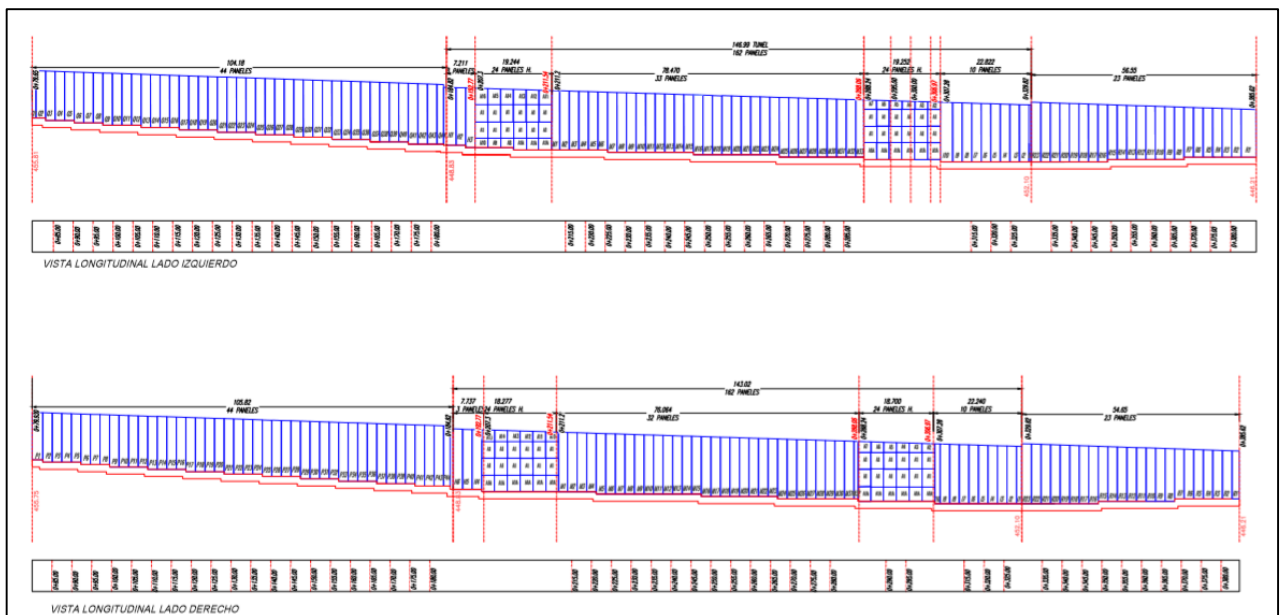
Perfil longitudinal de la viga portapanel (PLANO N° 33).
